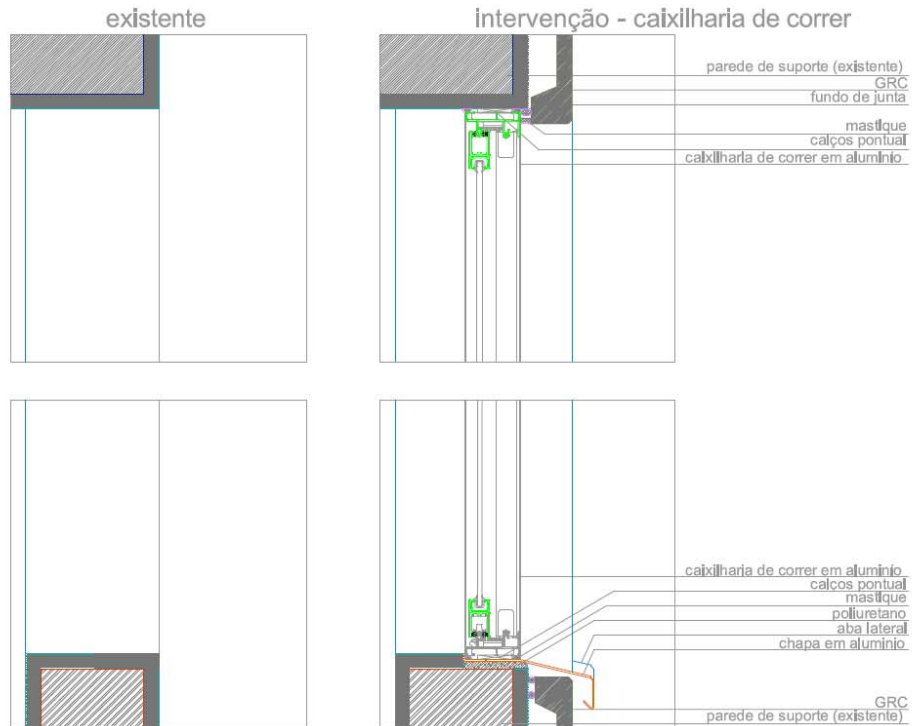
Novo caixilho de correr da lavandaria. Pormenor construtivo vertical (escala 1/10).
